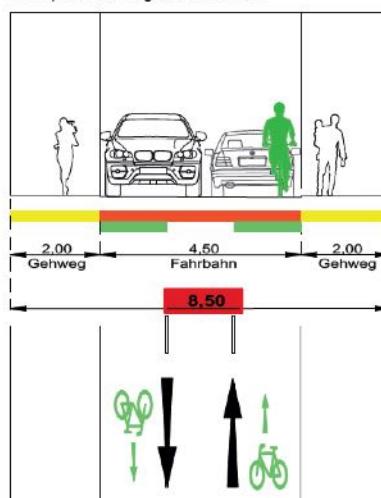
Querschnitt Planfall 5a und Planfall 5b, [Quelle: PLANUM]
